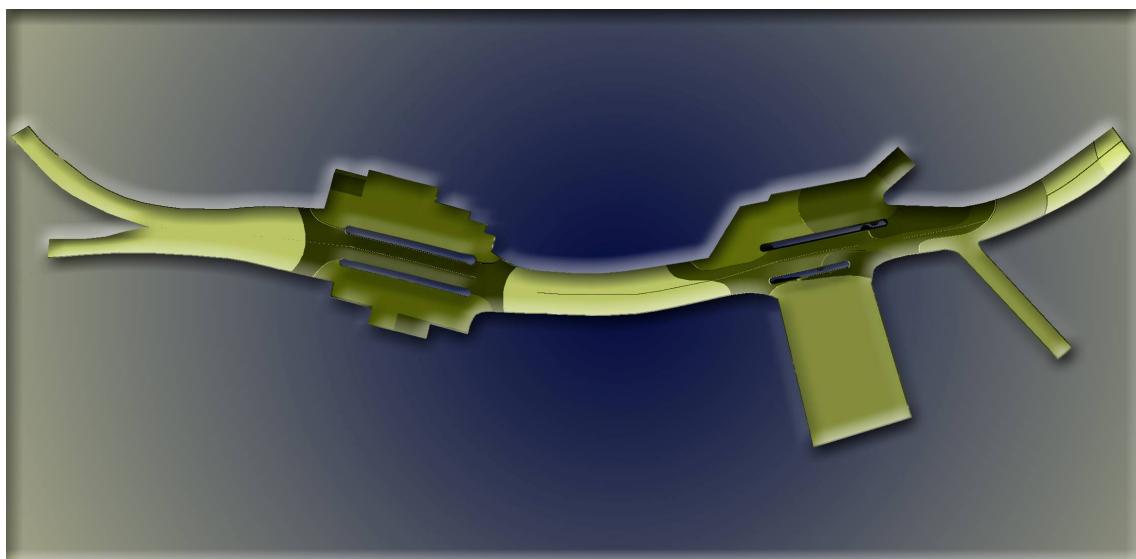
مسقط أفقي للنفق موضحاً عليه مناطق توزيع الأنشطة أ و ب و ج.
